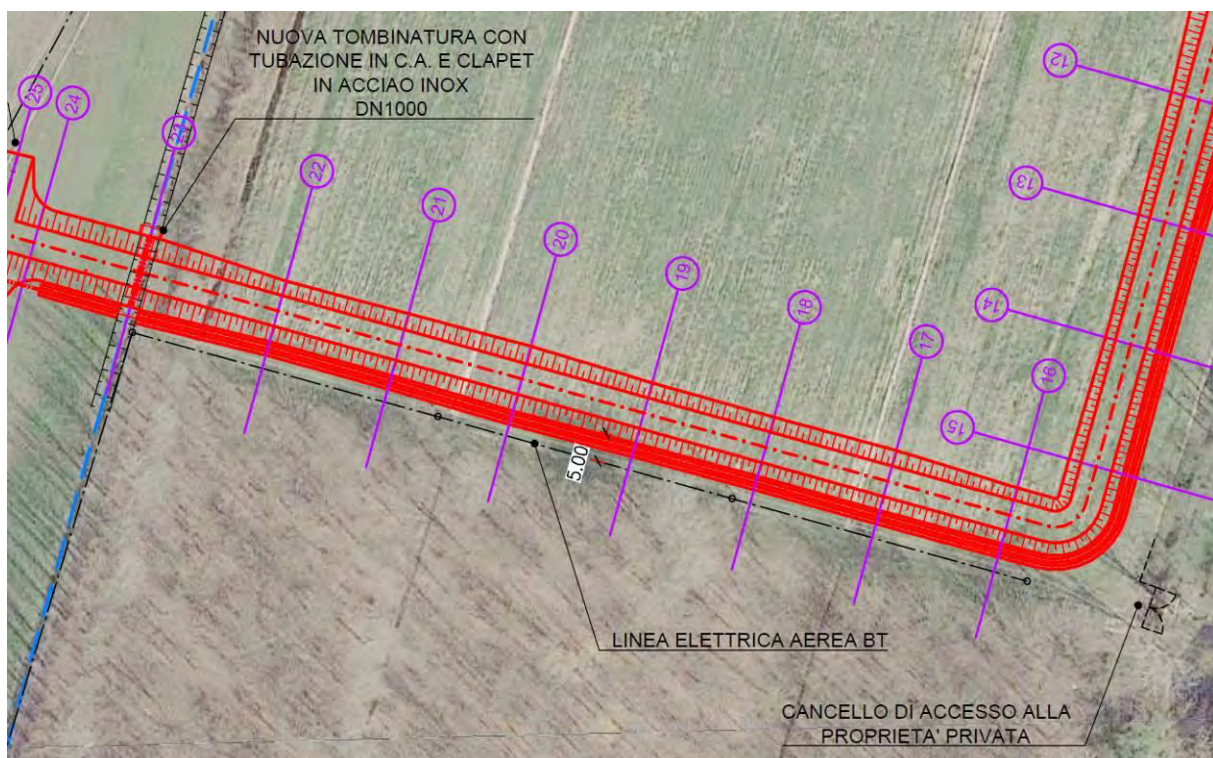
posizione linea elettrica BT in prossimità dell'argine in progetto (stralcio planimetria di progetto).
